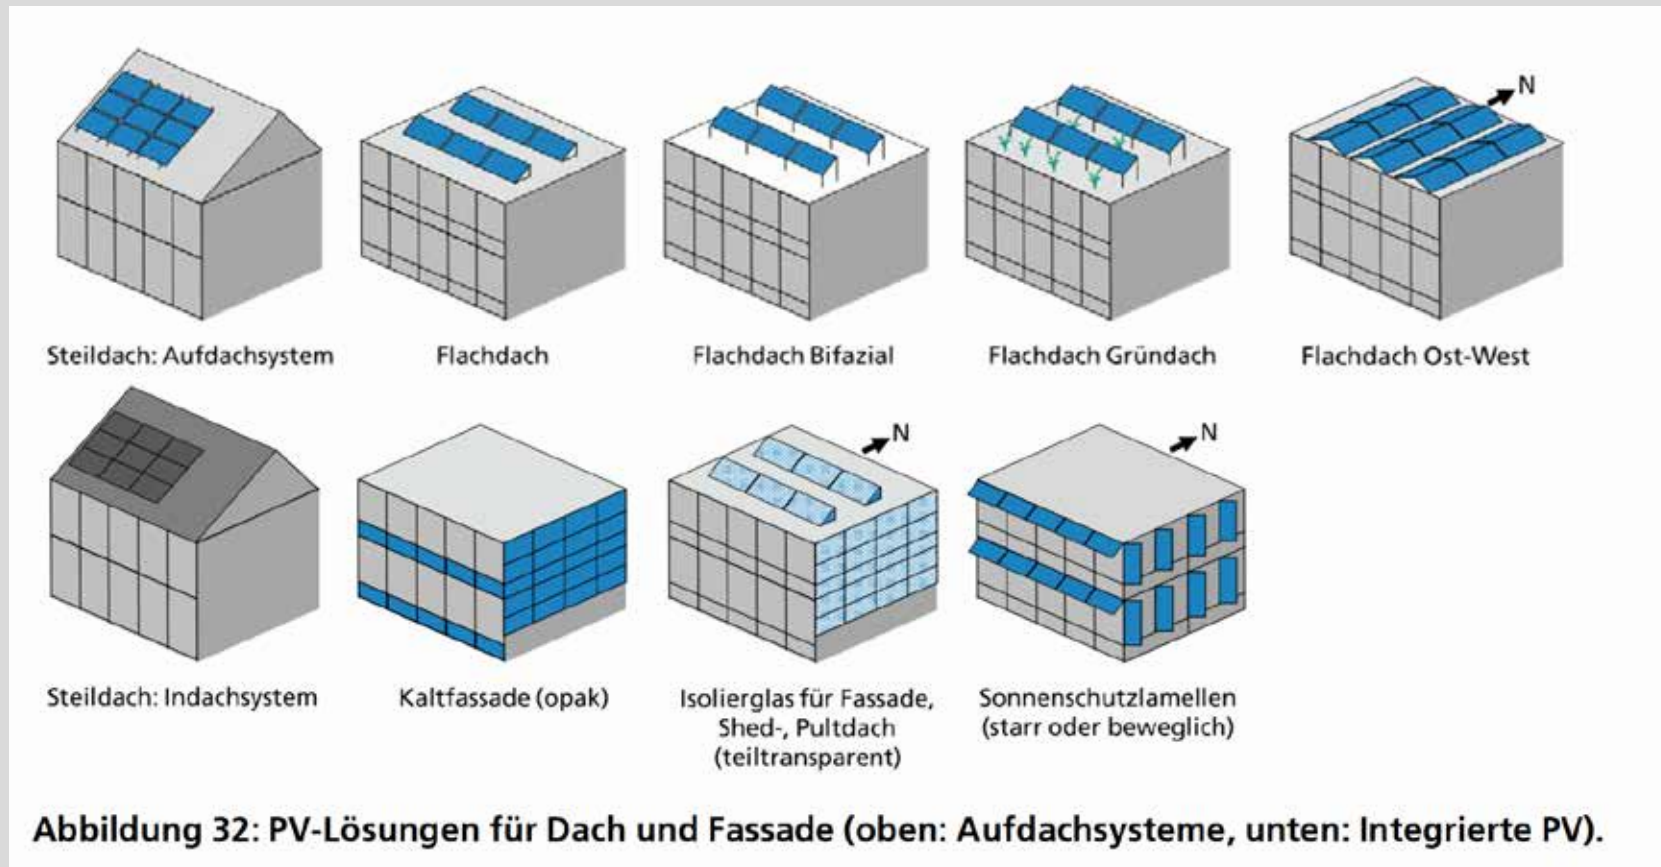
PV-Lösungen für Dach und Fassade (oben: Aufdachsysteme, unten: Integrierte PV).
